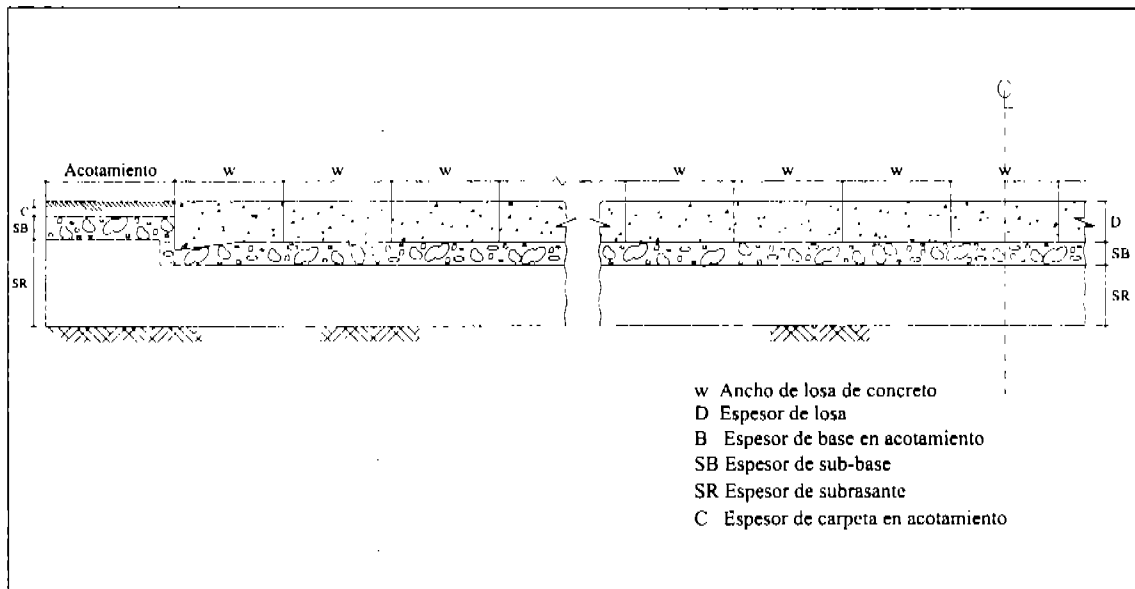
SECCION ESTRUCTURAL DE UN PAVIMENTO RIGIDO
